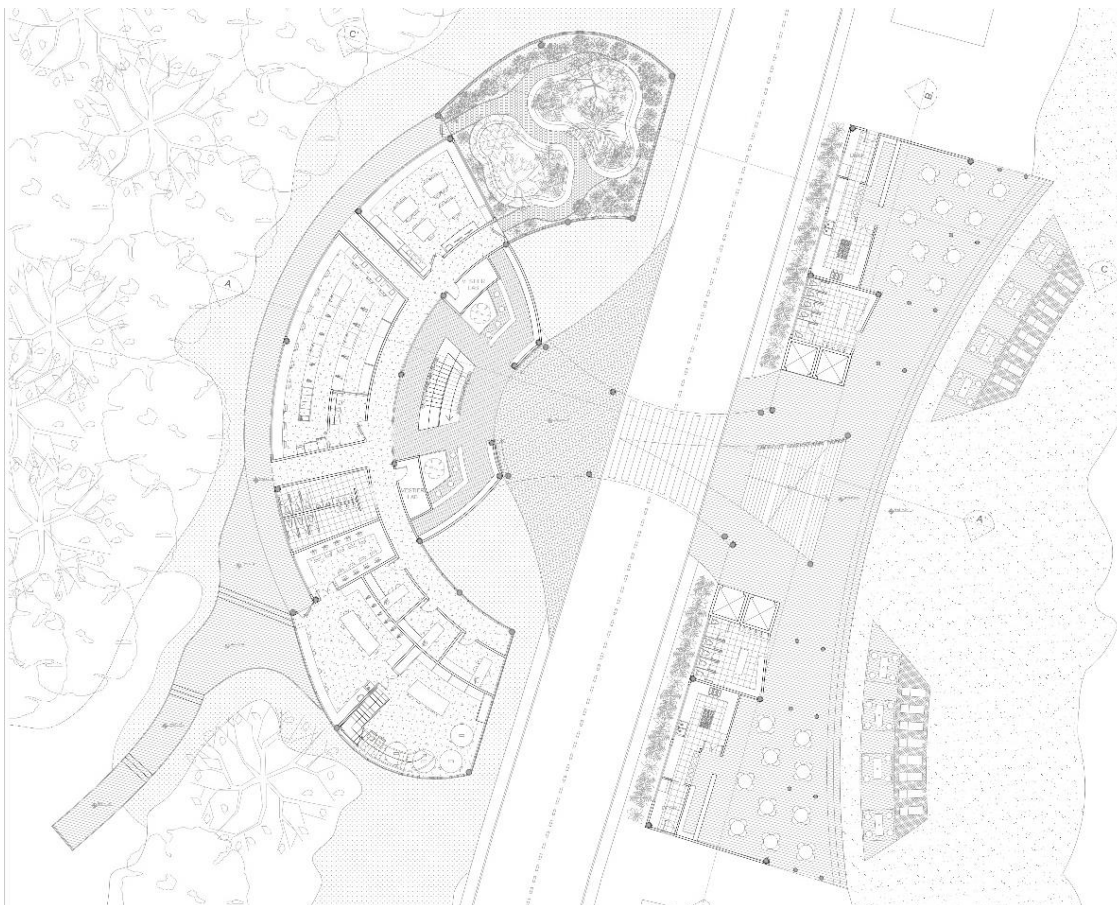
Planta arquitectónica nivel 1. Fuente: Elaboración propia (2023)
